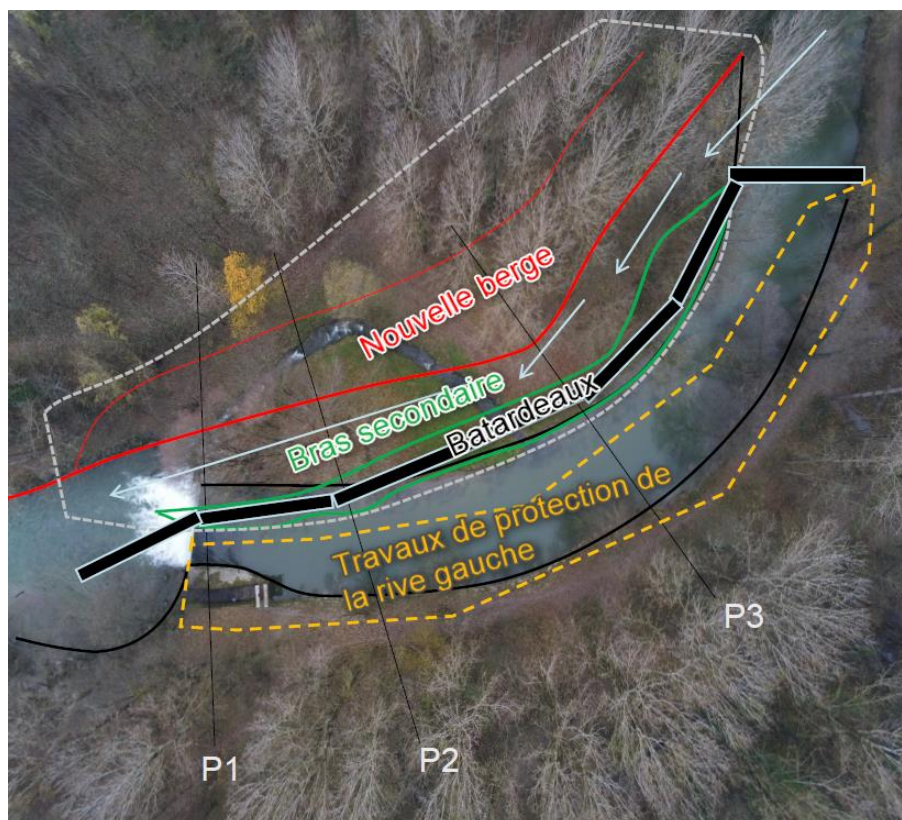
Étape 3 des travaux dans le secteur du seuil (construction de la rive gauche)
